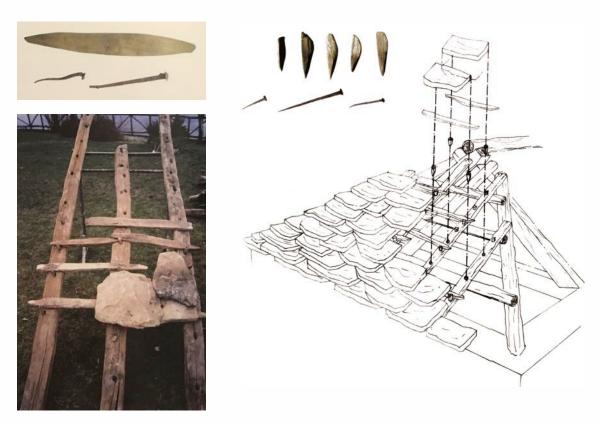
Schema applicativo Disegni e foto tratte da PAESAGGIO, ARCHITETTURA E PIETRA DI LANGA - Lorenzo Mamino, 2008
